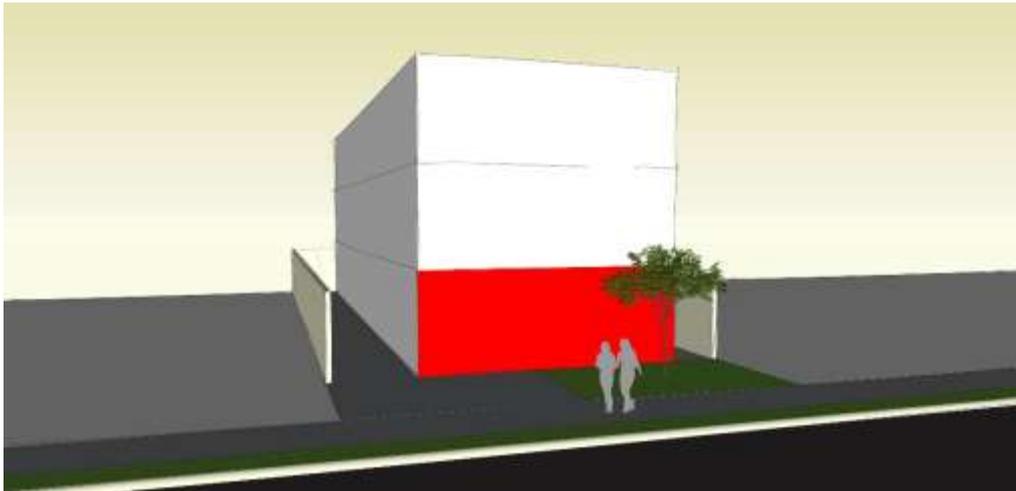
Imagem esquemática da fachada ativa em indústria e comércio – opção 1
